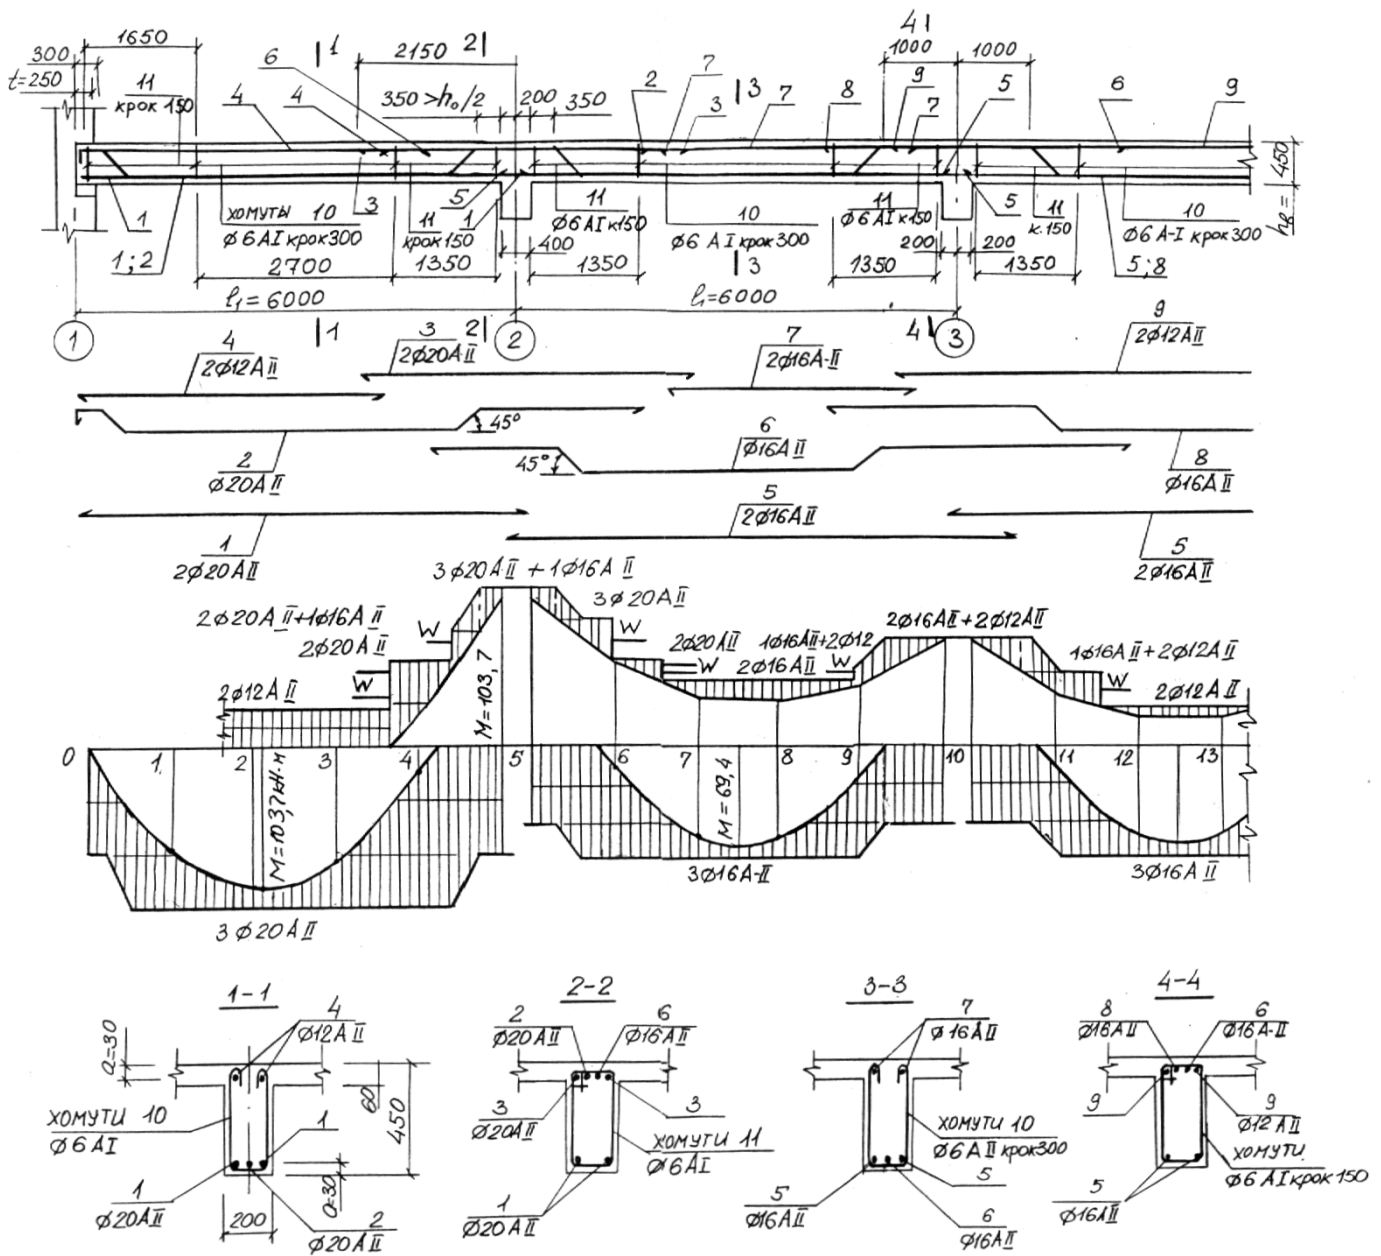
Армування другорядної балки в'язаною арматурою із окремих стержнів
